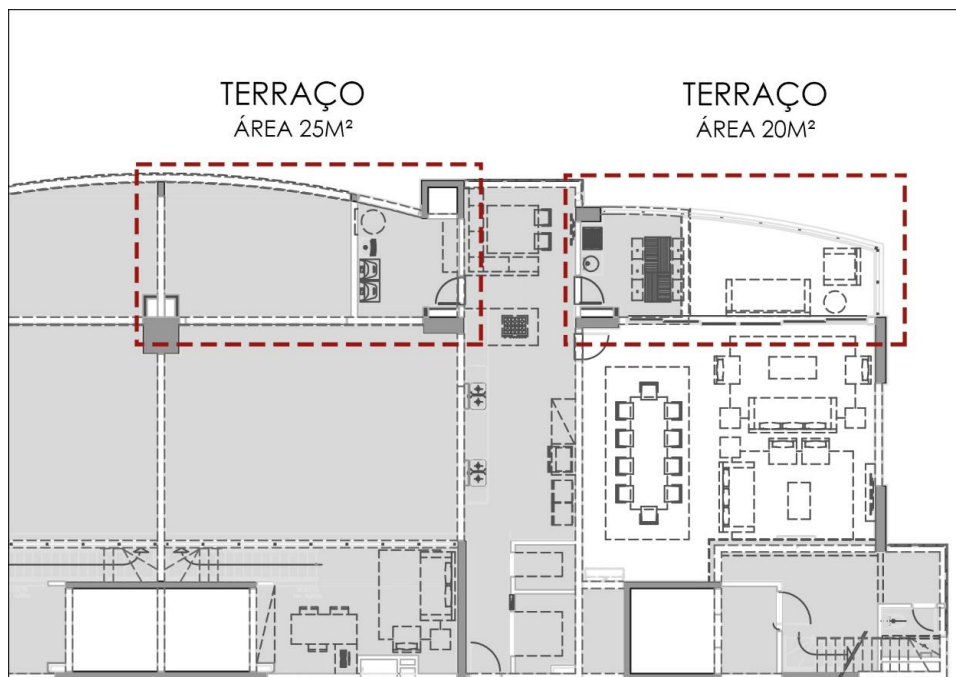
Detalhe dos terraços - planta de arquitetura do empreendimento “A”. Fonte: Planta Arquitetura Empreendimento “A” (modificado pelo autor).
